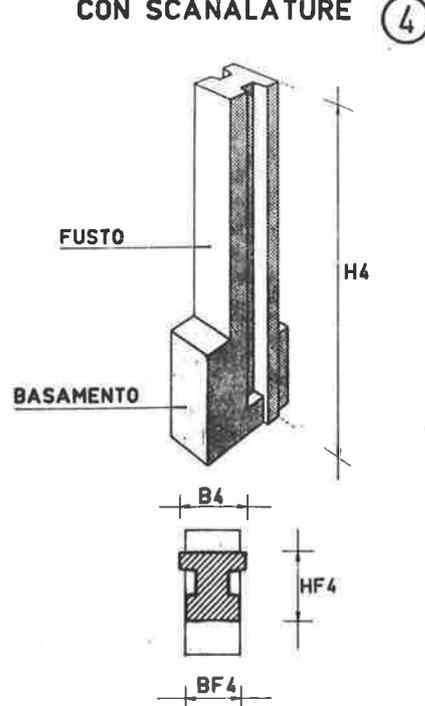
,2,3 e 4 Schema descrittivo degli elementi montanti spalla, dell'elemento montante pila e dell'elemento montante con scanalature
